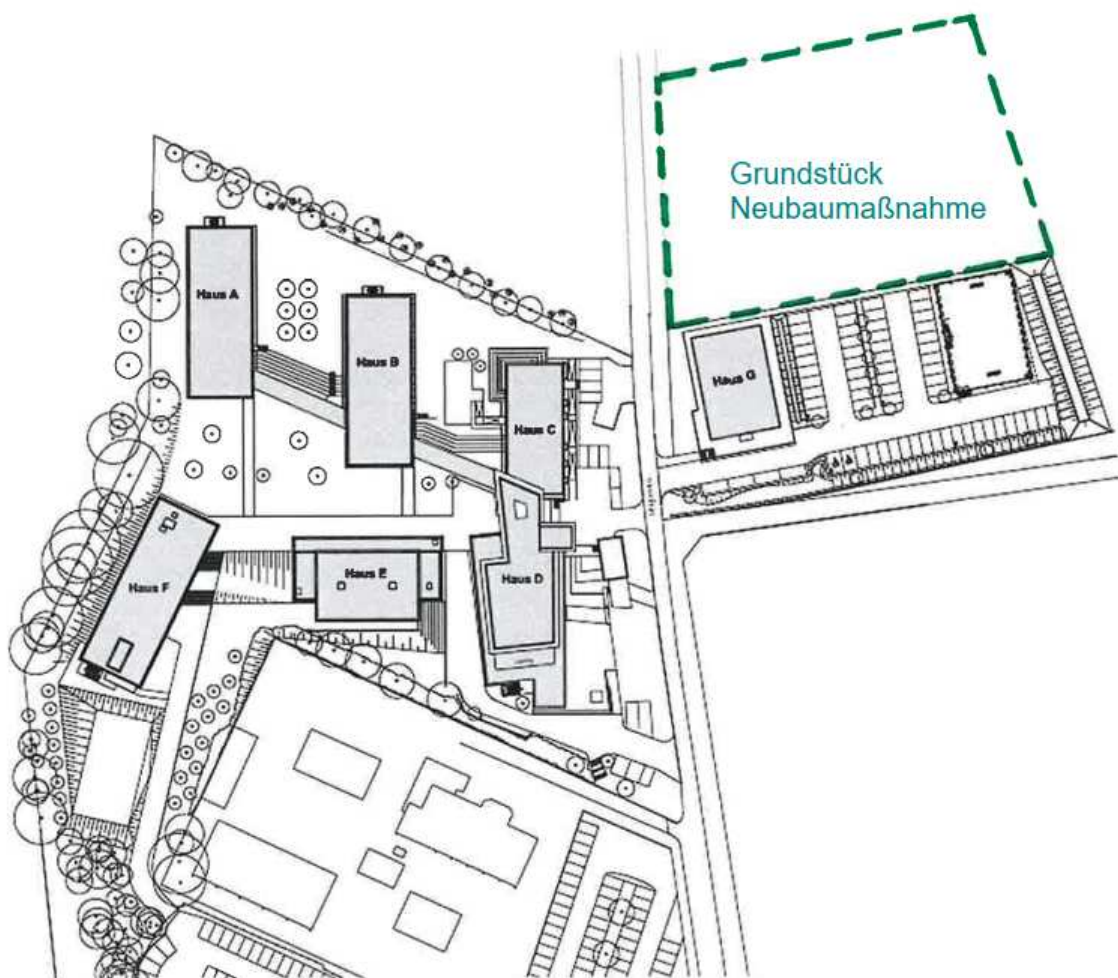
Lageplan mit Darstellung der erworbenen Grundstücksfläche (gestrichelte Linie)
